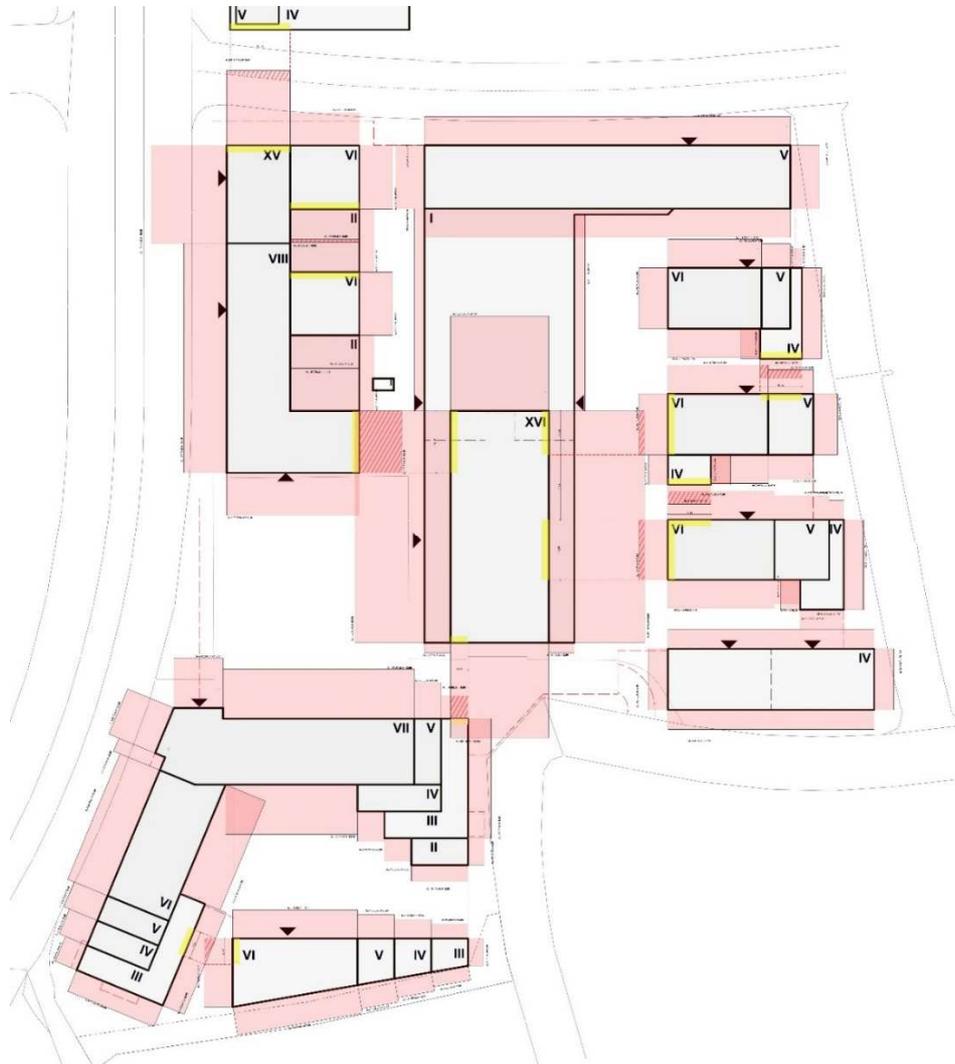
Abstandsflächenplan (ssp-architekten, 28.01.2025)
